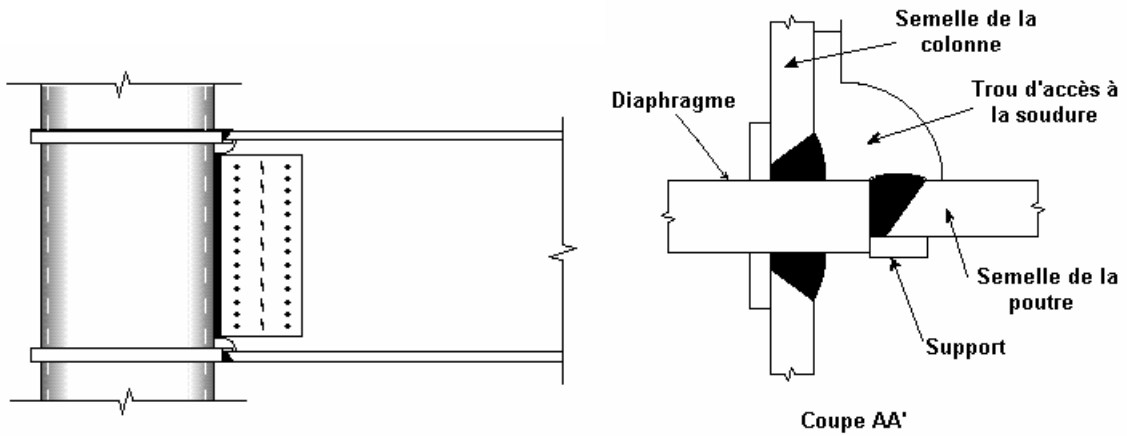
Assemblage poutre-poteau réalisé sur chantier
